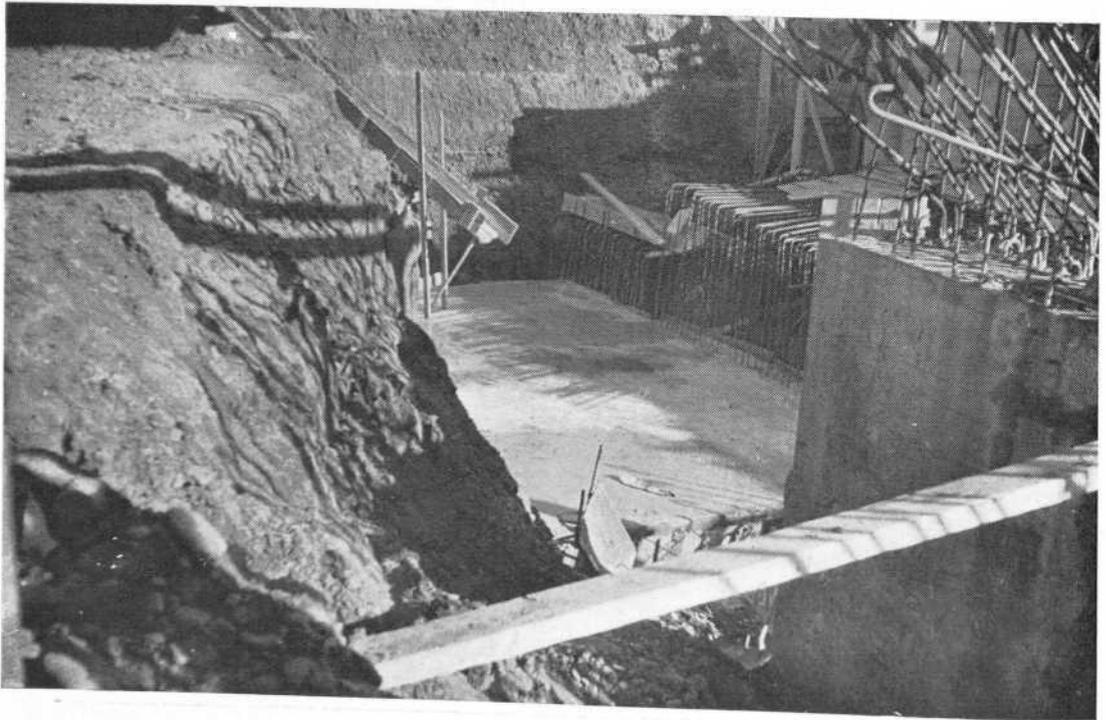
Cimentación del Silo de Burgos. Vista parcial del cajón indio y foso de elevadores.
